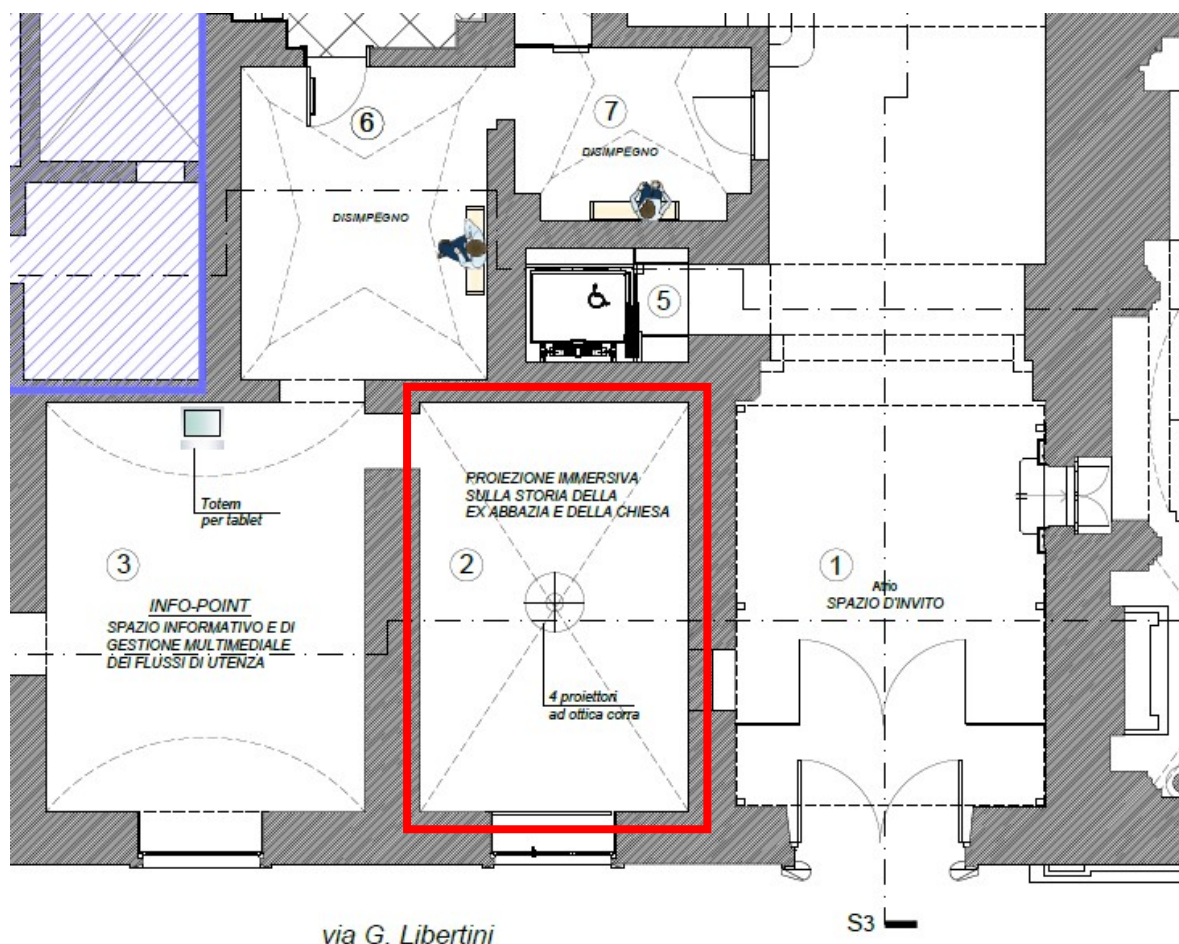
Stralcio della planimetria del piano terra con individuazione della sala immersiva (rosso)
